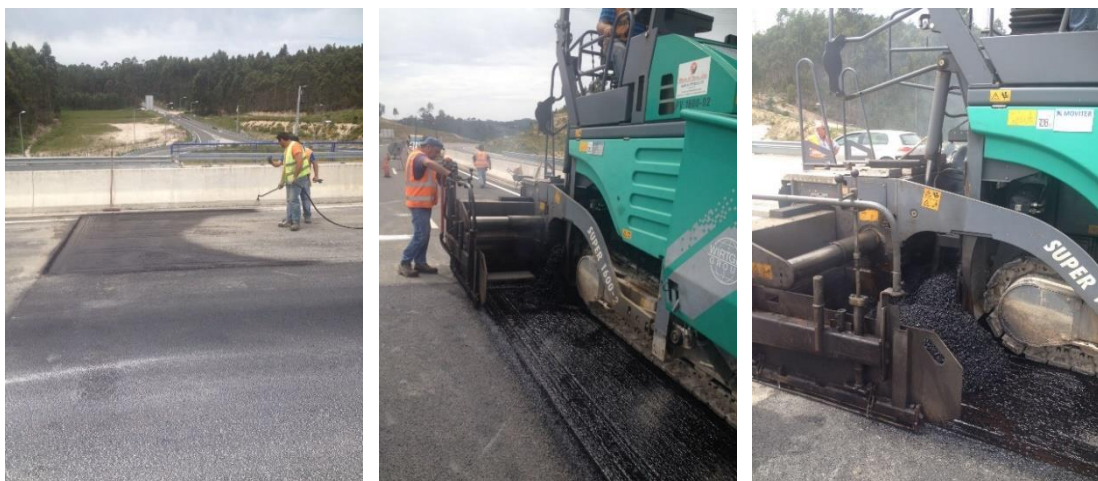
Reabilitação - aplicação de camada betuminosa drenante em troço do IC9
